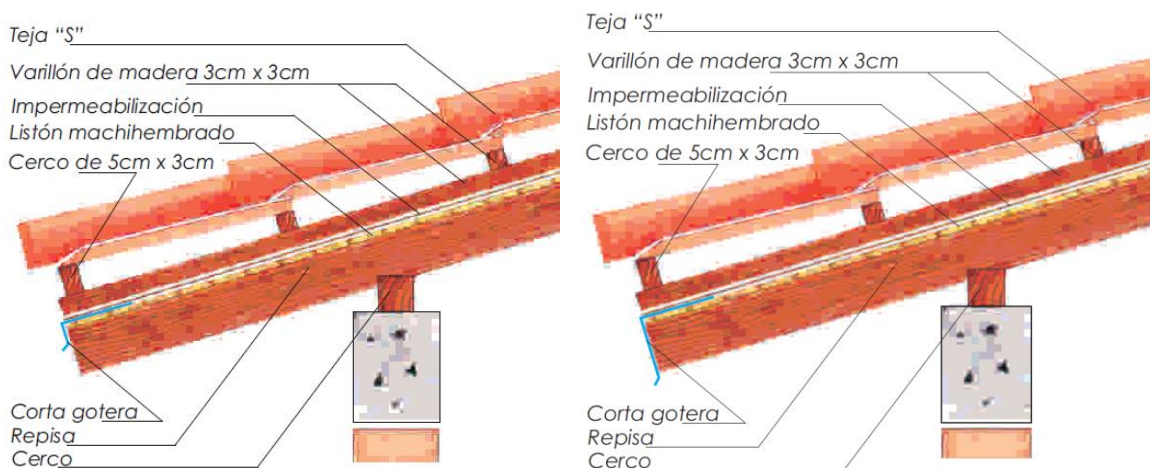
Detalle teja "S" sobre listón machihembrado, impermeabilización y varillón o listón, rematado con cortagotera.
